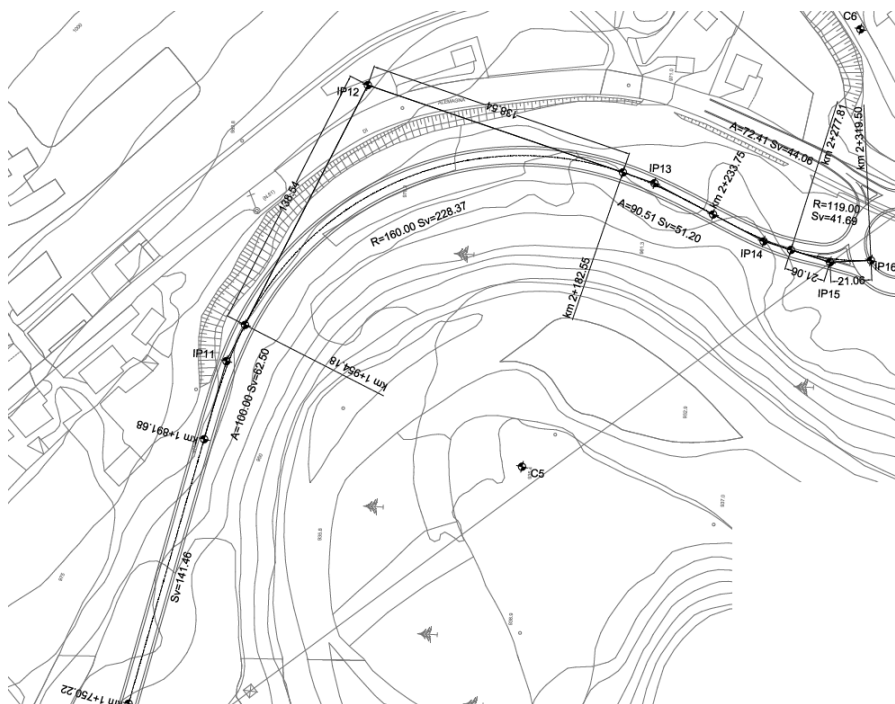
Stralcio del tratto finale della planimetria di tracciamento PD
